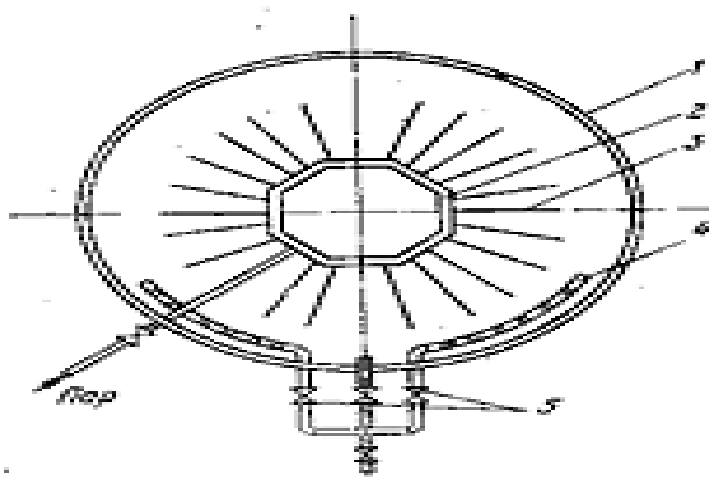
Система предотвращения отложений в резервуарах для светлых нефтепродуктов: 1 — корпус; 2 — кольцо; 3 — перфорированные трубки; 4 — перфорированный коллектор; 5 — штуцеры
